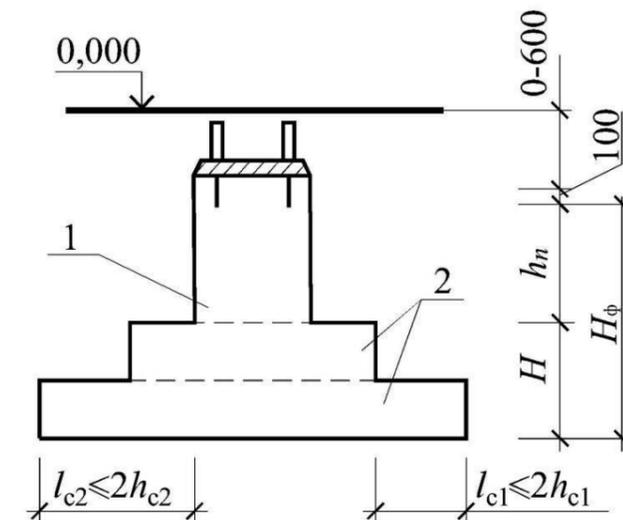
Столбчатый фундамент при соединении со стальной колонной. 1- подколонник; 2- плитная часть фундамента; 3- подливка; 4-анкерные болты.
